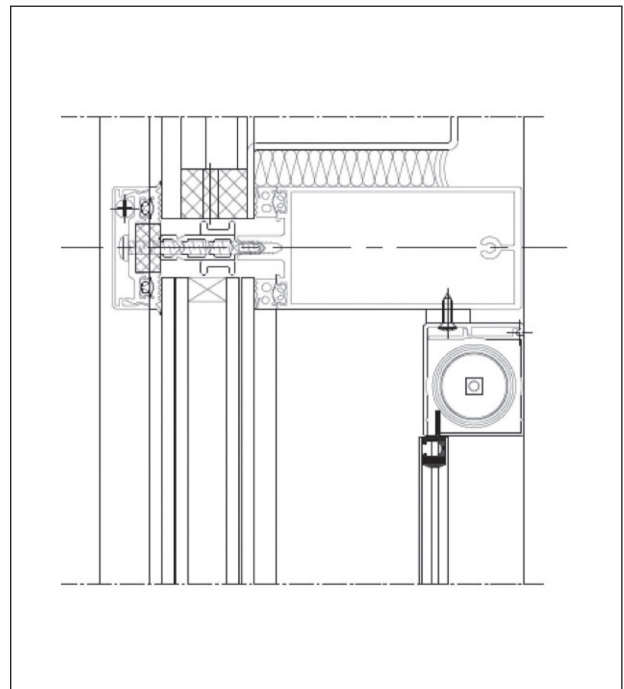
Pfosten-Riegel-Montage mit eckiger Kasette, Einbau unter dem Fassadenriegel (Ansicht beispielhaft)
